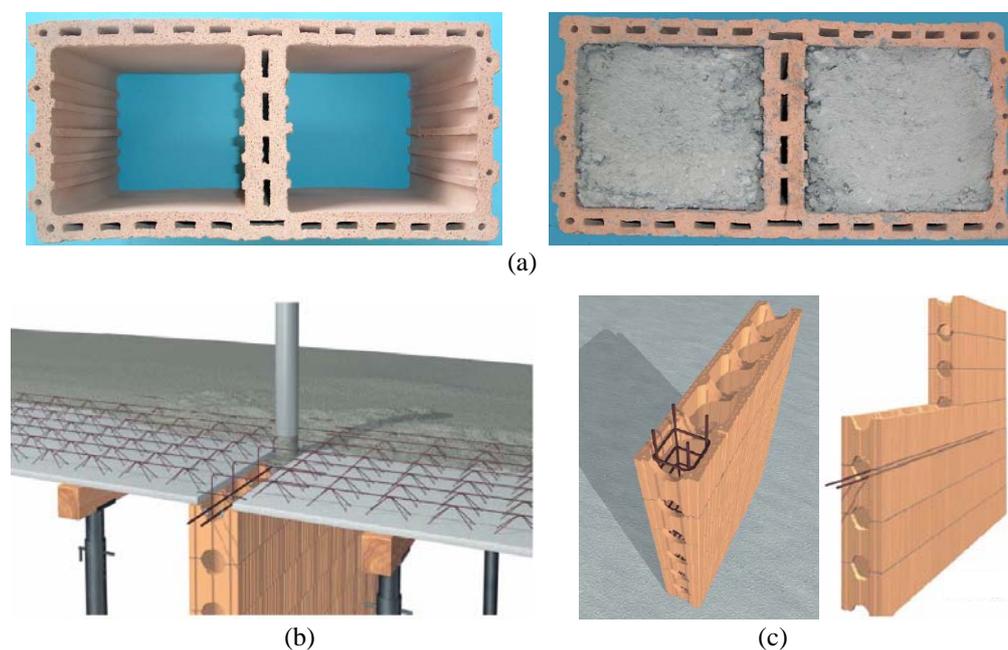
Alvenaria moderna armada (solução em desenvolvimento na Alemanha): (a) bloco de alvenaria com furos de grande dimensão para preenchimento com betão auto-compactável; (b) sistema de paredes e laje a betonar em conjunto; (c) detalhes da armadura [6].
